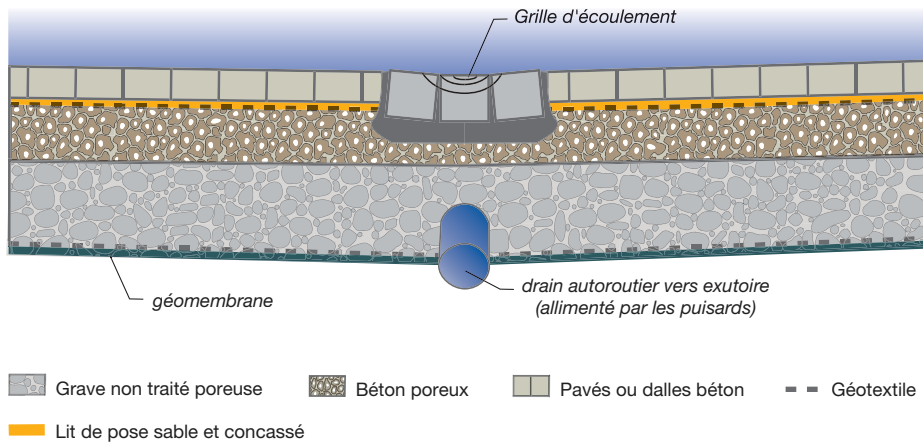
structure réservoir en béton hydraulique poreux revêtue d'un dallage avec évacuation.
